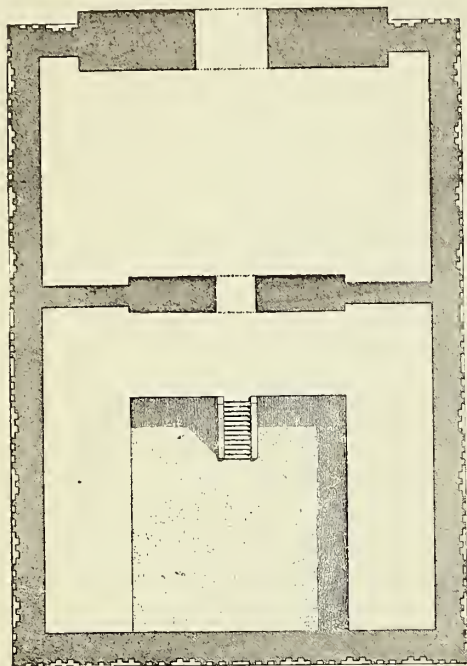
PLANTA DE UNA TUMBA DE EL-ASSASIF (SEGÚN PRISSE)
